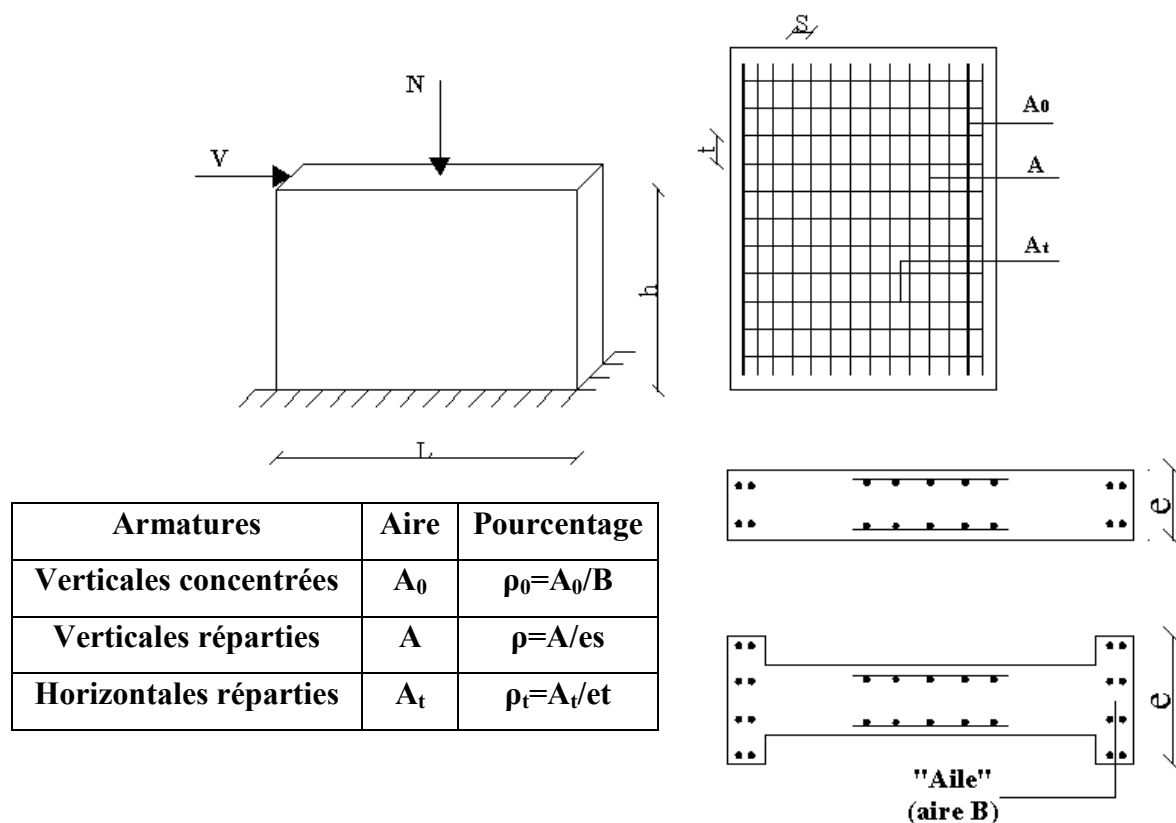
Schéma d'un voile plein et disposition du ferrailage
